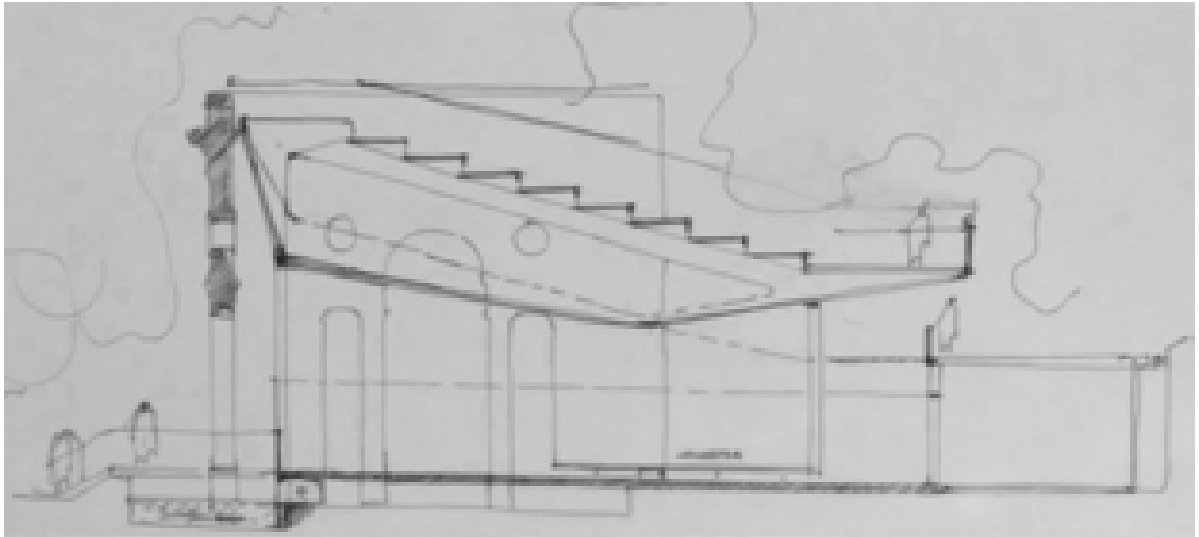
Terza ipotesi di sezione trasversale tipo (AABS-949)
